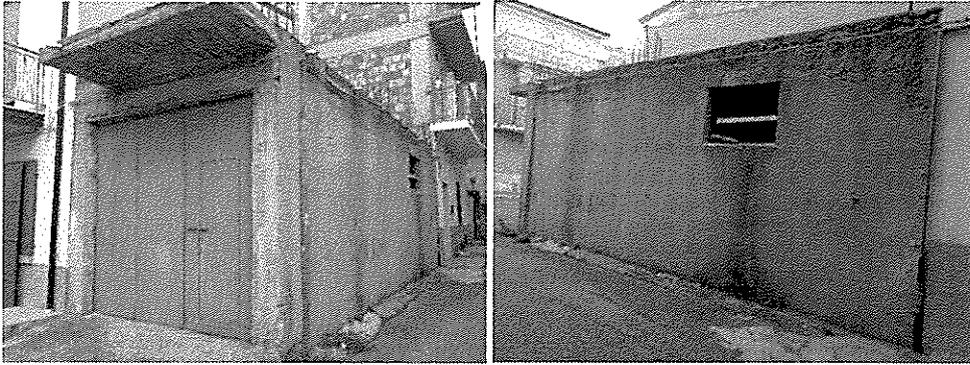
e 4 – Facciata nord-ovest e facciata sud del magazzino in Cutro Via Ortocasazza n. 27.
